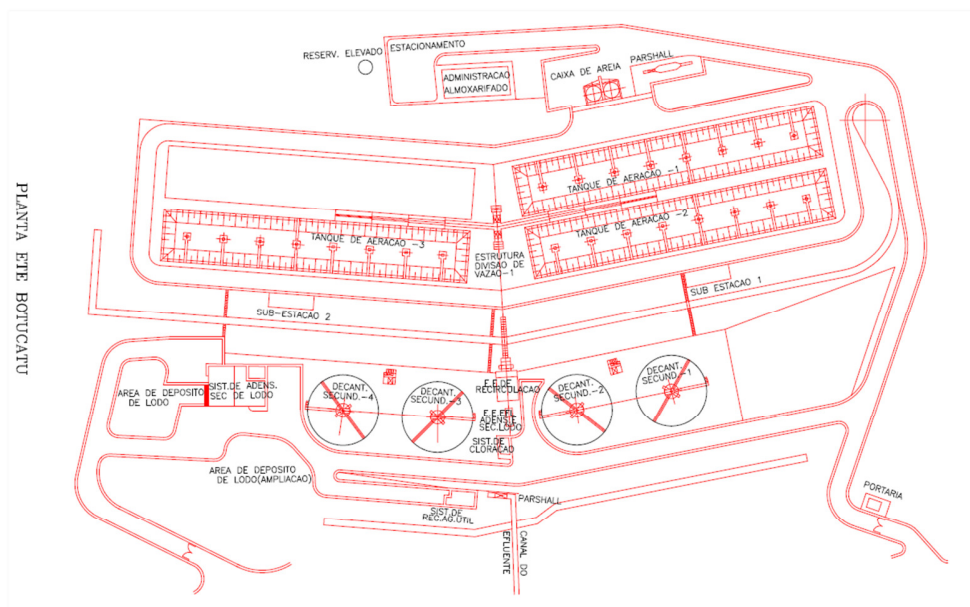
Planta da ETE Lageado - Sabesp de Botucatu
